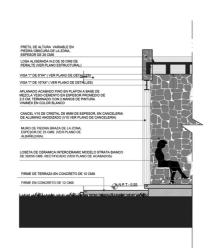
Detalle sección fachada Fuente. (ArchDaily, 2017)
